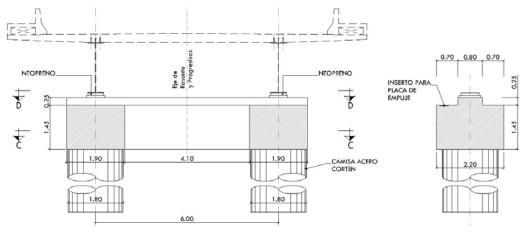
Pórtico de Pila (Diámetro 1.80 m) – Corte y Vista
